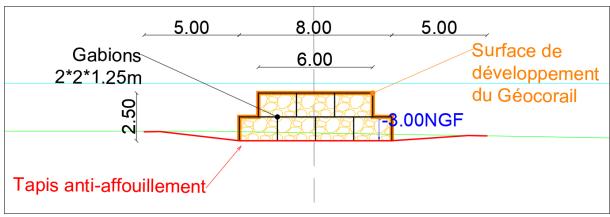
Coupe type selon B-B' du brise lames en géocorail sur la plage du Centre-Ville
